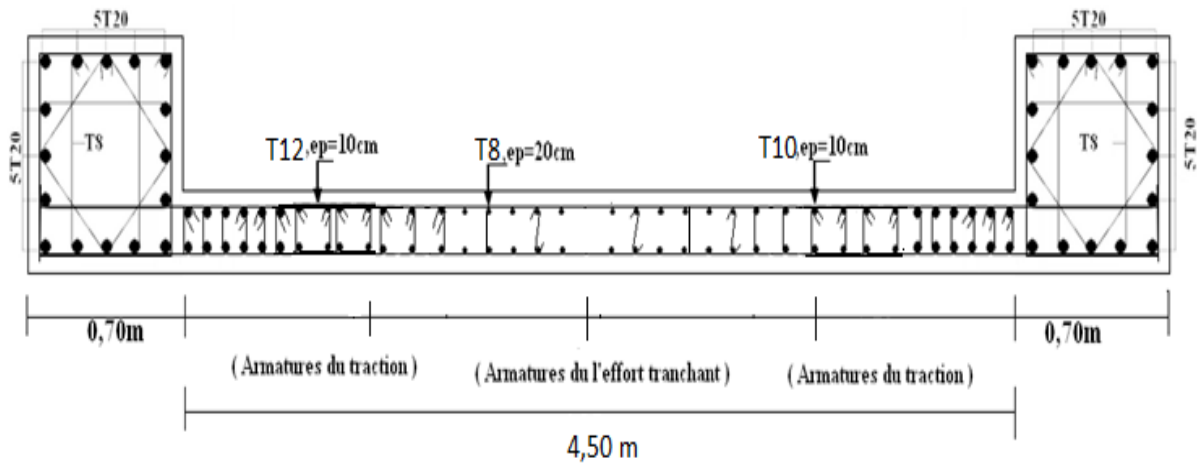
Schéma de ferrailage des voiles (V1 et V2) coupe horizontal.
